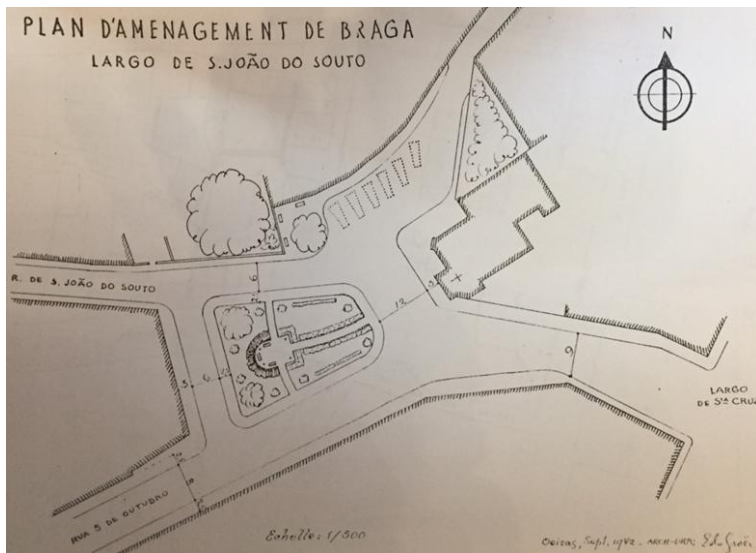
Planta do Largo São João do Souto, 1942, esc.1/500.
